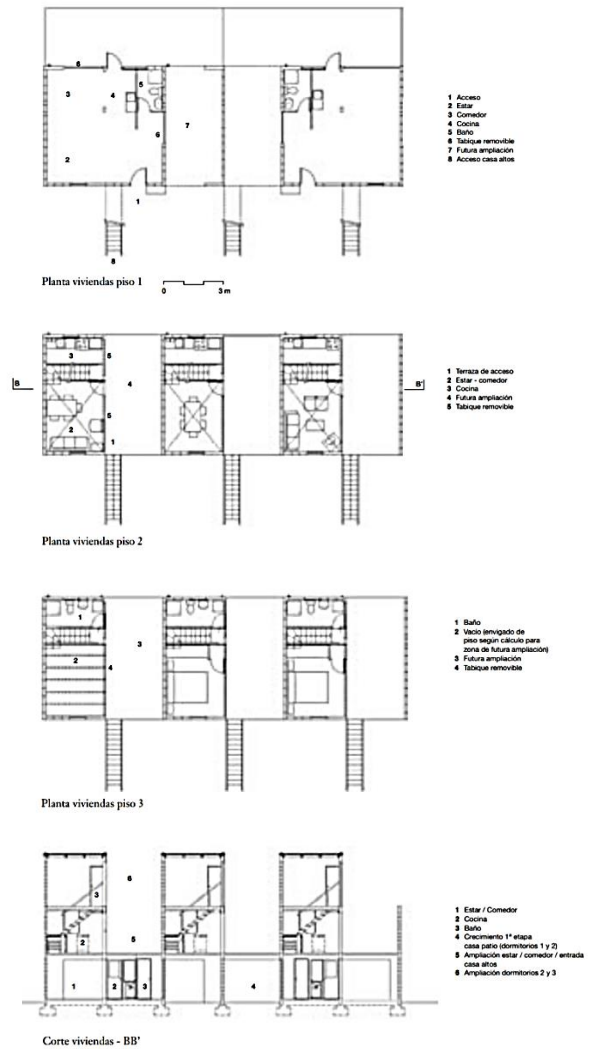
Plantas y corte de un bloque de viviendas. Fuente: Revista ARQ obras y proyectos (Chile, 2015).
